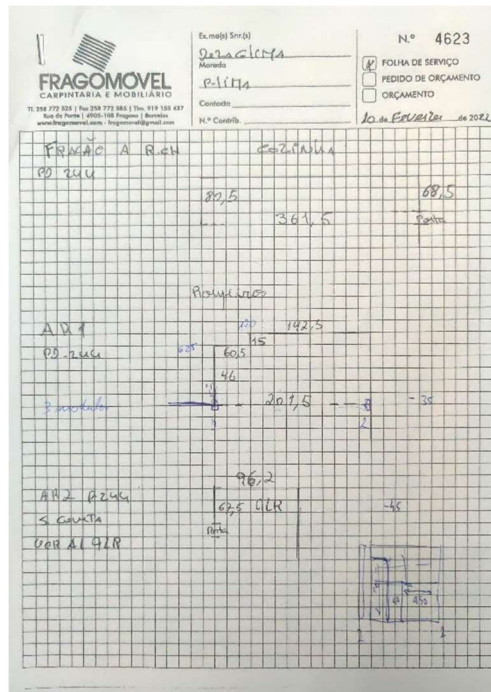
Exemplo levantamento das medidas retiradas em obra
